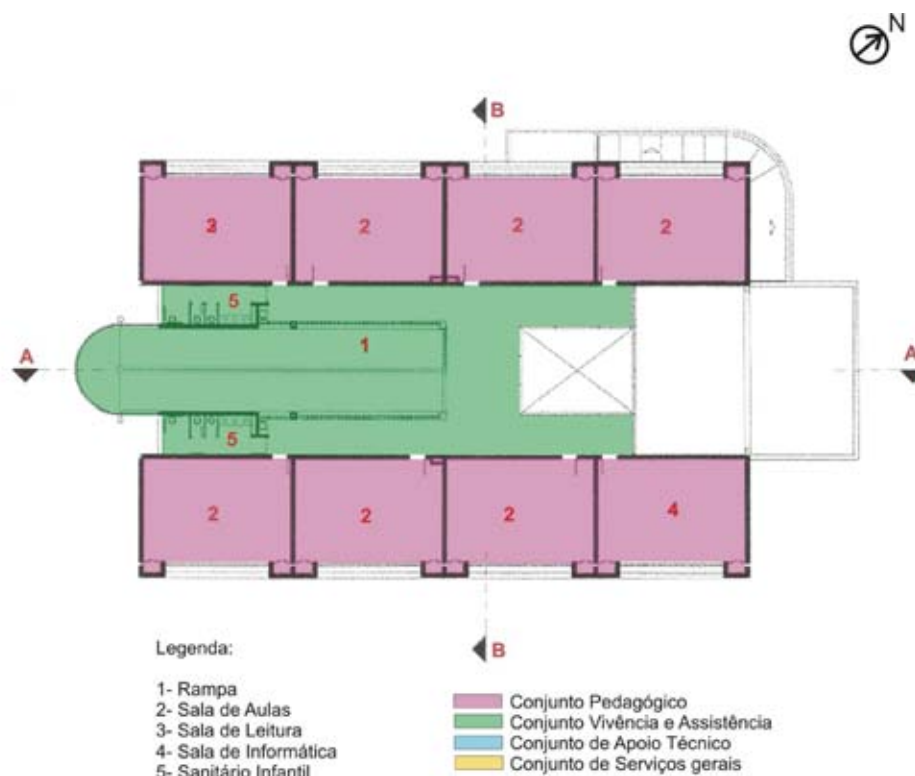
2º Pavimento da E. M. Tia Ciata
